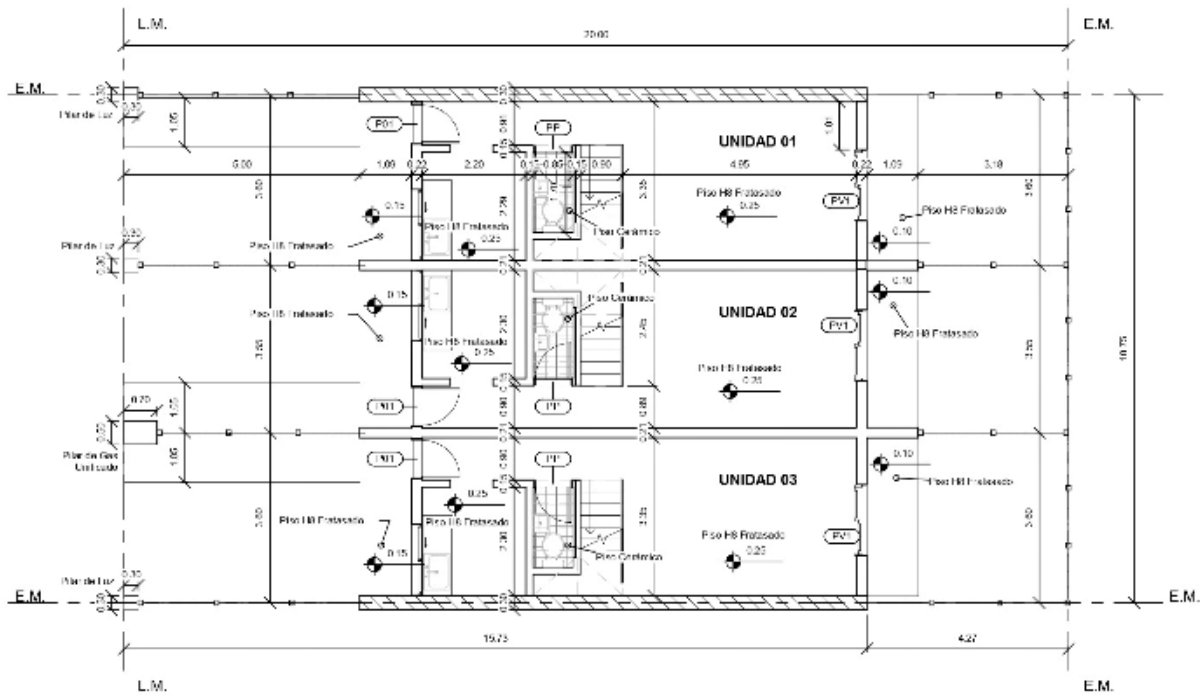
Planta Baja Dúplex prototipo DU 3.6 M
